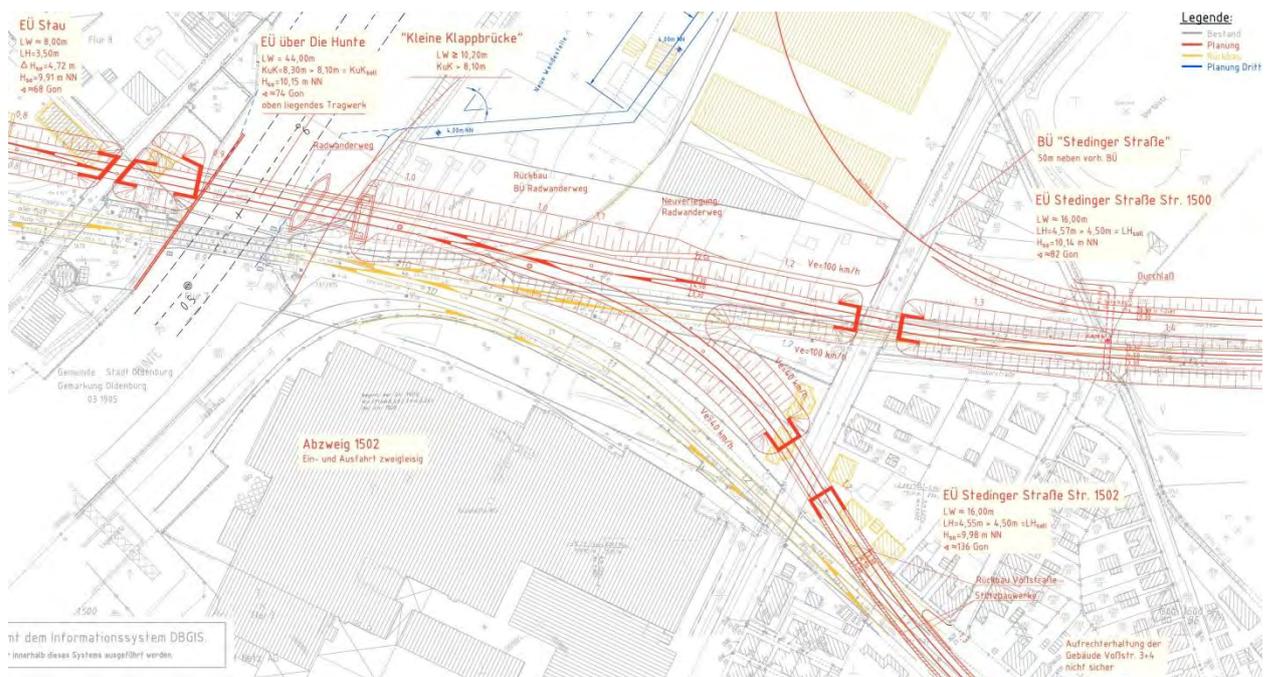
Lageplan „Kleine Klappbrücke“ – Ausschnitt (Quelle: DB ProjektBau GmbH, „Kleine Klappbrücke“ (Stadt Oldenburg) – Ergänzung zur Untersuchung der Machbarkeit vom 26.01.2009, Hannover, Stand 24.06.2010)
